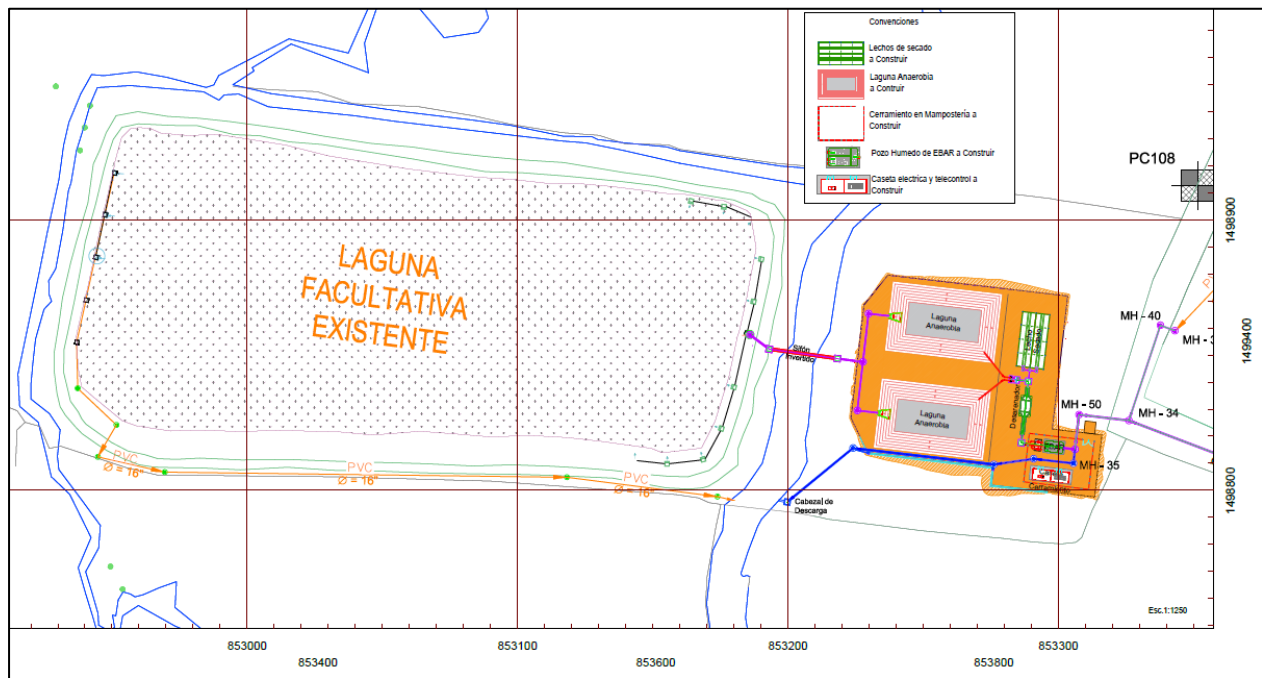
Tomado del plano de estructuras existentes y proyectadas.
